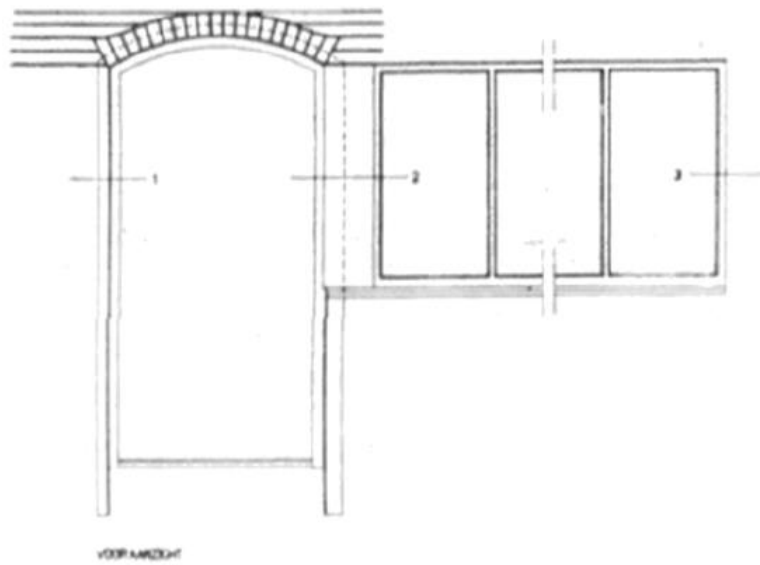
Detalle fachada sur. Fuente: Bouwkundig\_weekblad\_Architectura 56E Jaargang 1935
